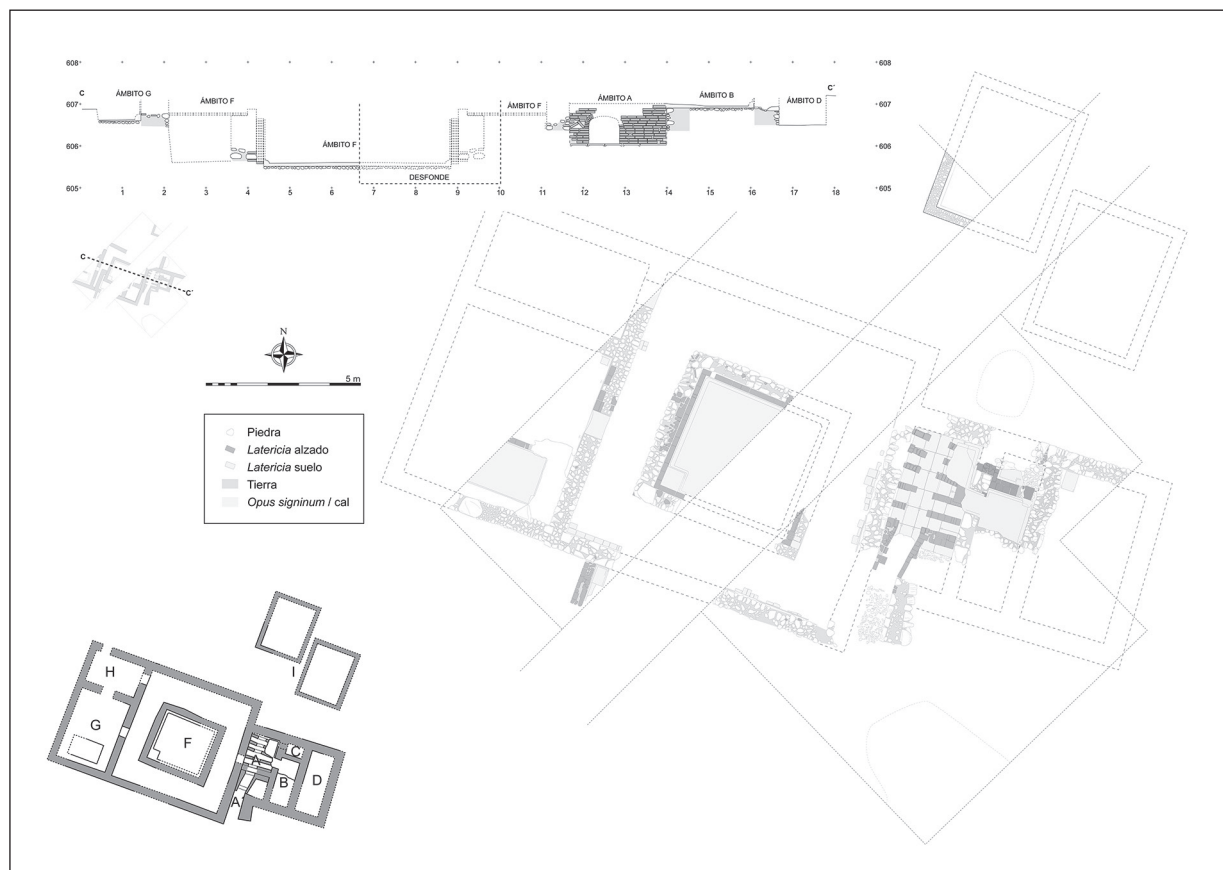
Planimetría y sección de la segunda fase en las áreas A y B.
